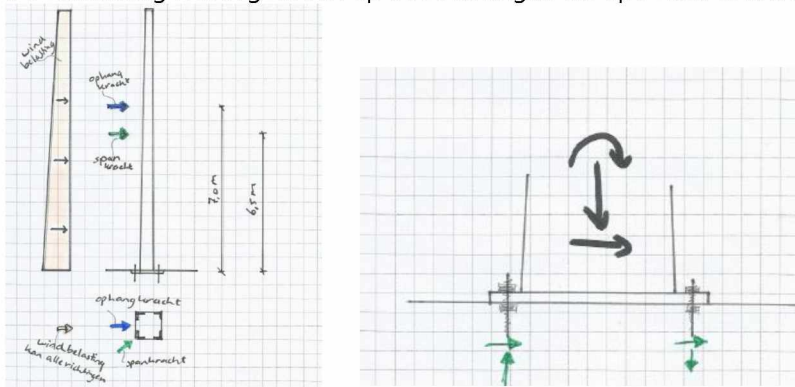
bovenaanzicht en zijaanzicht betongedeelte en ankers
